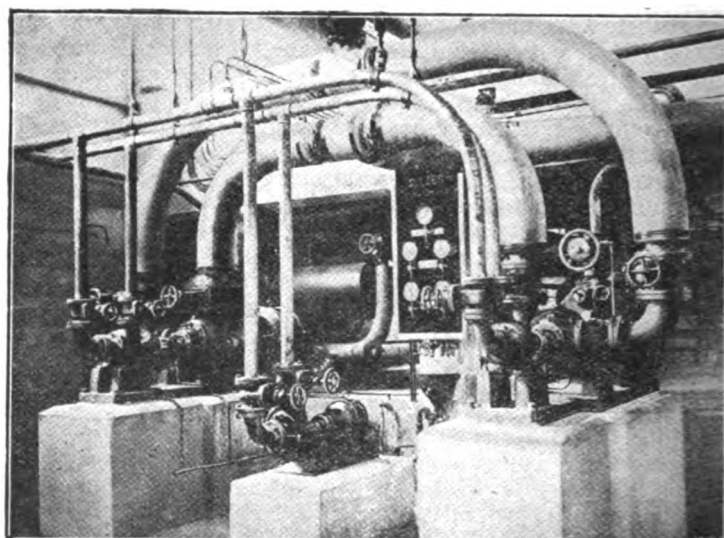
Groupe turbo-pompe de la centrale de l'asile de Stefansfeld.
